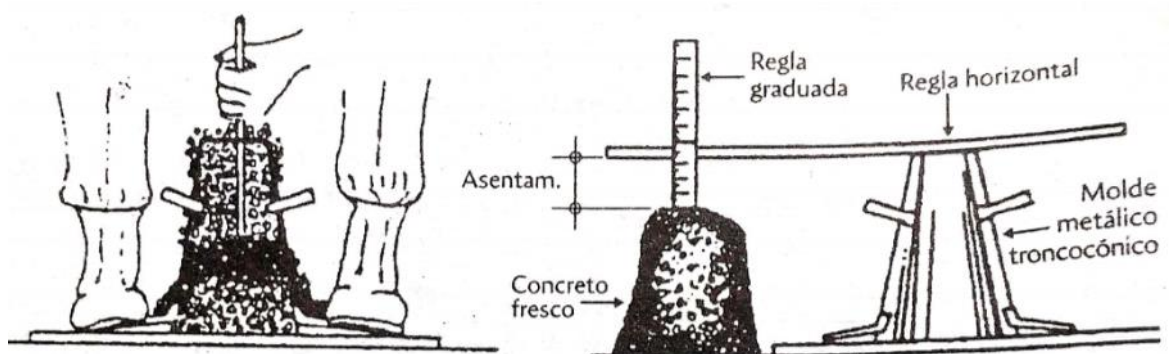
Equipo para prueba de asentamiento en el concreto.
